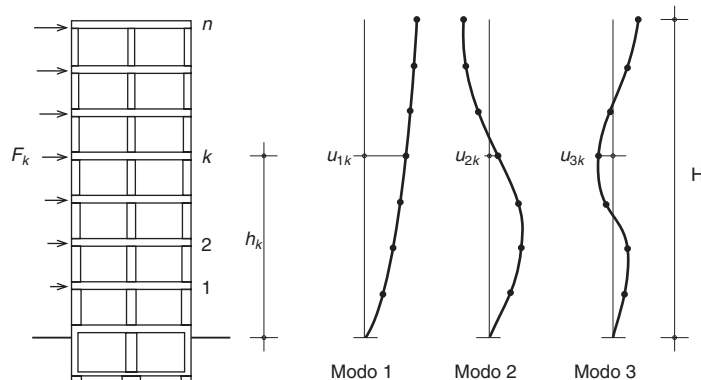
Modos de vibración en modelos planos de estructuras de pisos
